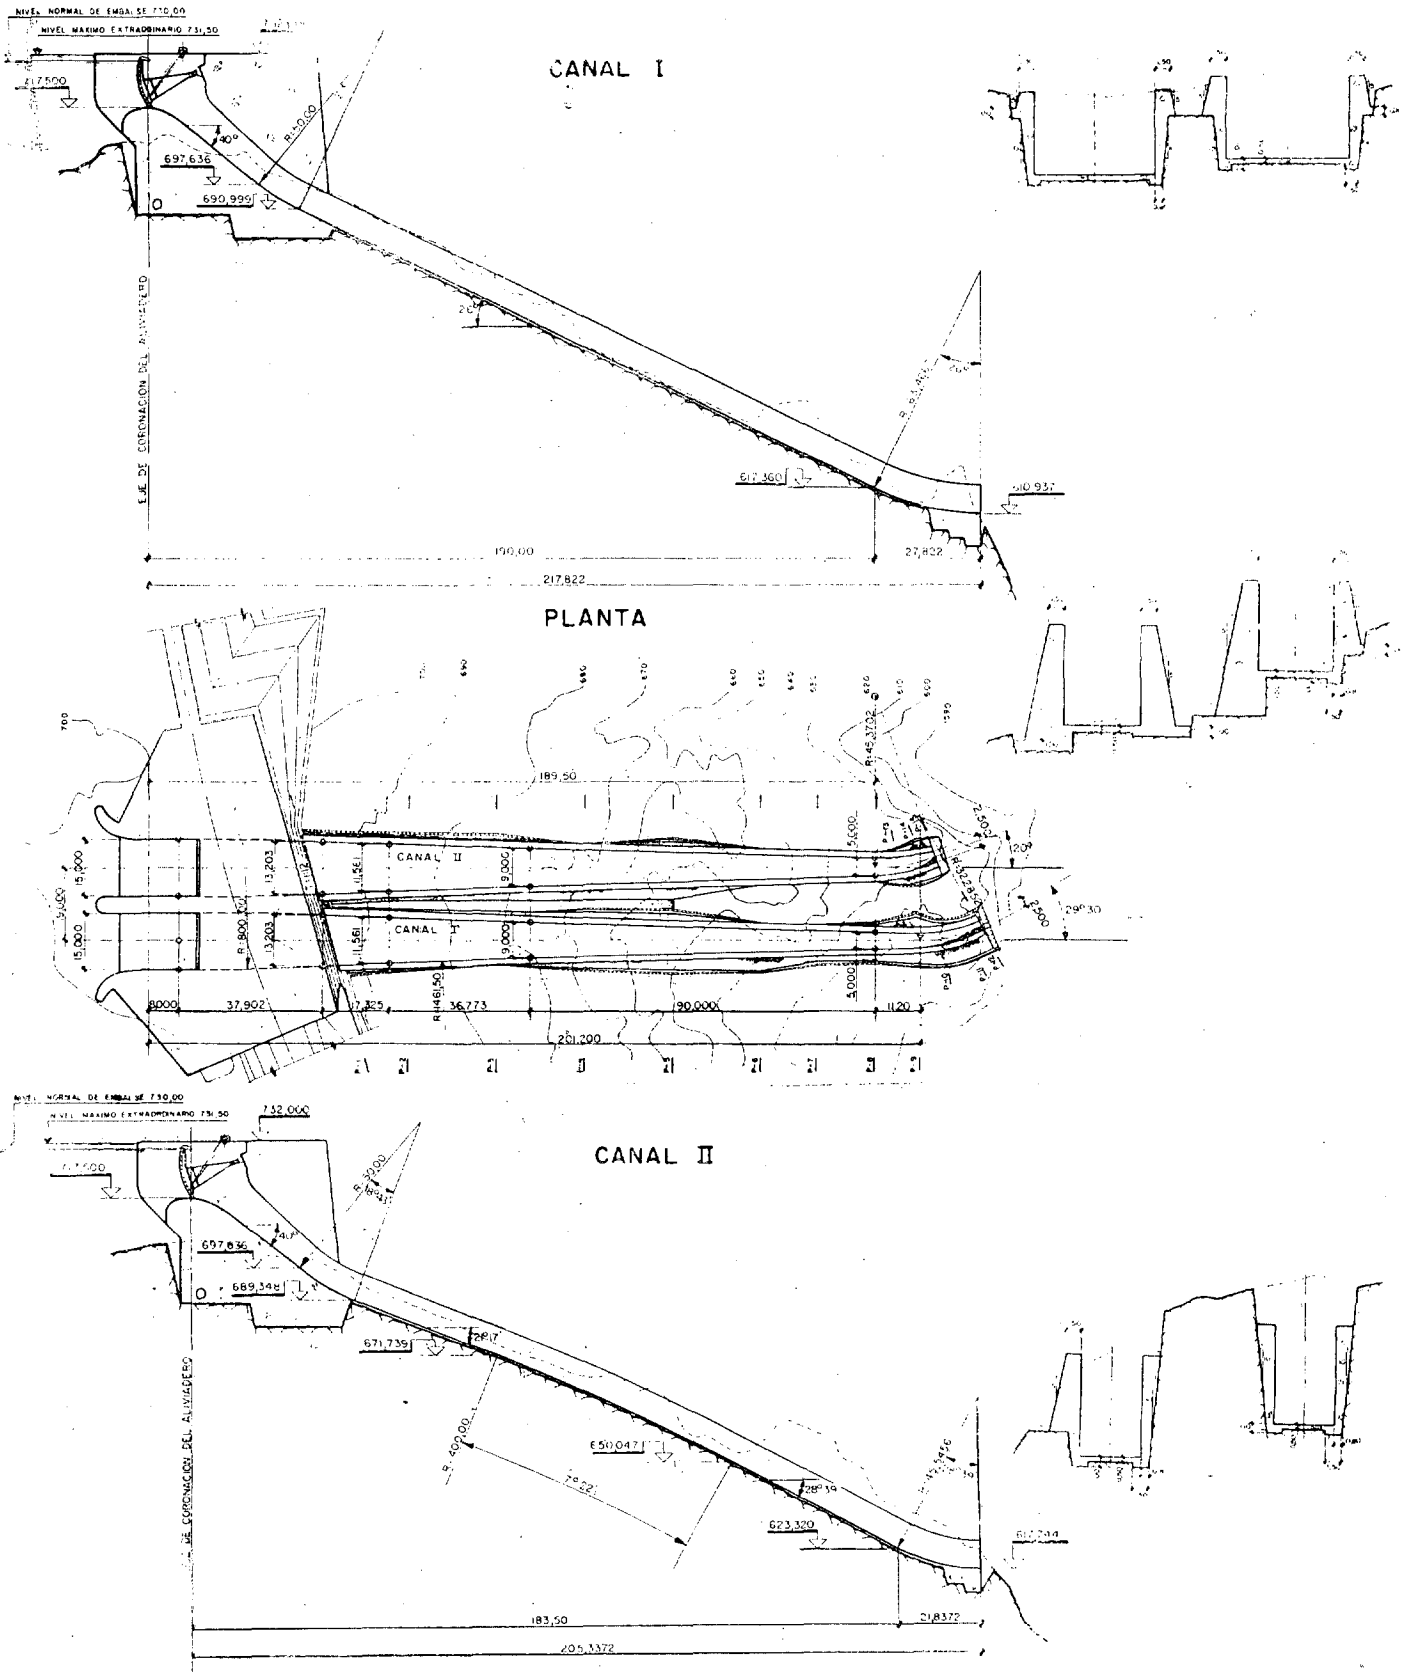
Aliviadero de superficie. Planta y perfiles longitudinales, y secciones tipo.
